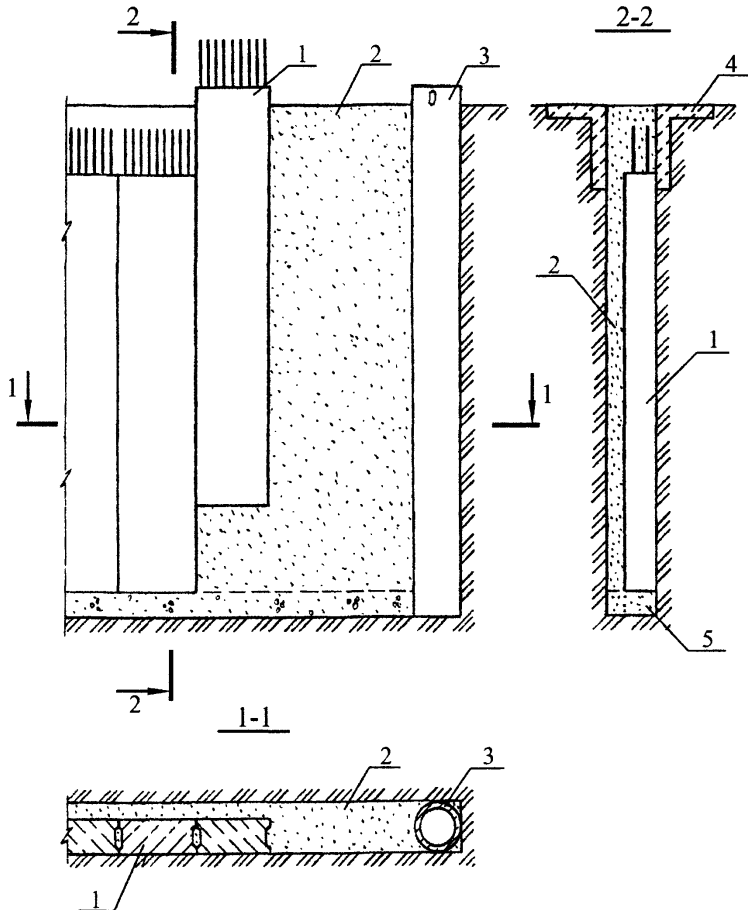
Схема производства работ при возведении стен способом «стена в грунте» из сборного железобетона
